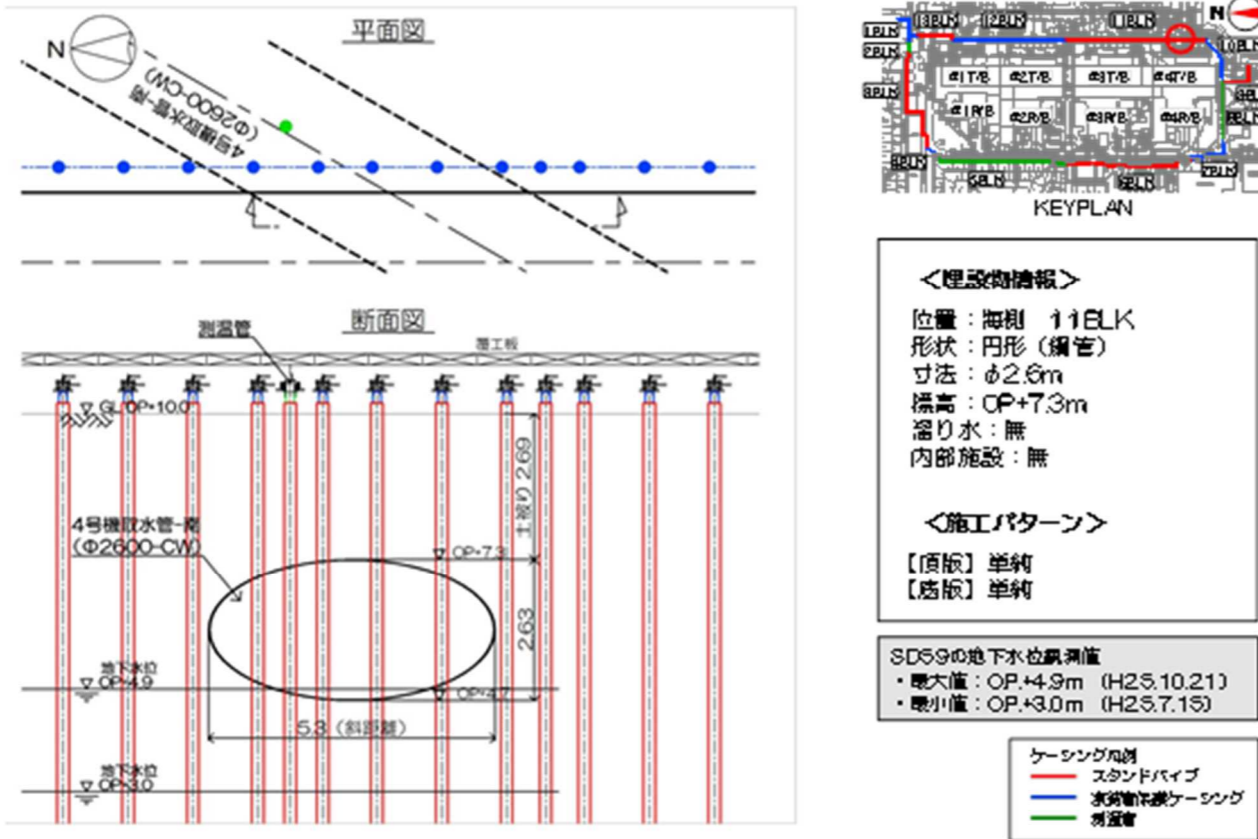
【11-1】4号機取水管-南 施工方法(貫通施工)
